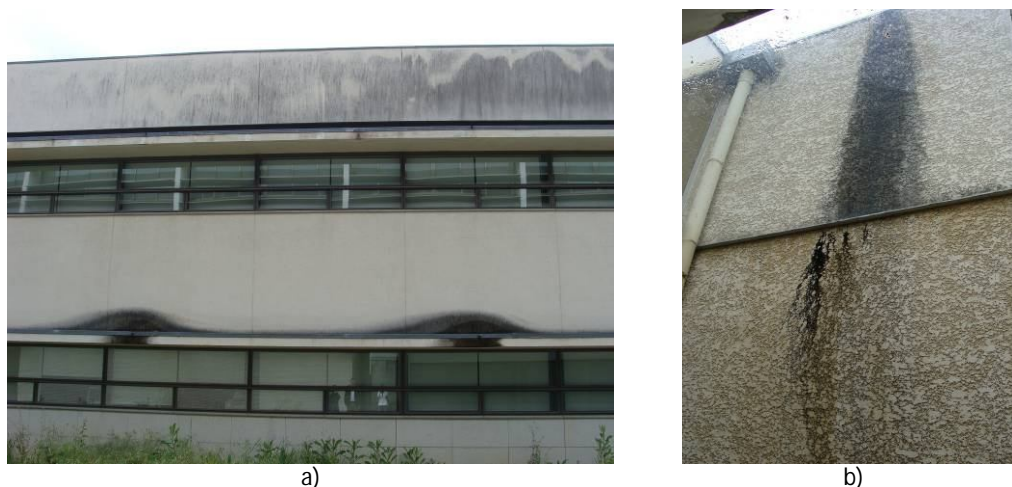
a) Fachada revestida a painéis de betão (edifício construído em 2001, no Campus de Azurém). Lado noroeste. Desenvolvimento de filmes biológicos devido a sistema de drenagem incorrectamente projectado; b) Fachada revestida a reboco cimentício de edifício construído em 1995, no Campus de Azurém. Lado norte. Colonização biológica associada à má execução das obras.
